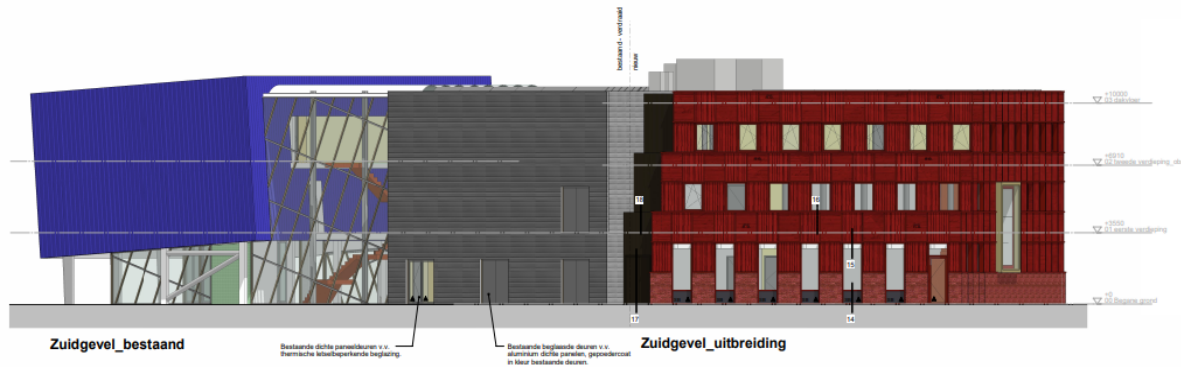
Situatietekening ligging uitbreiding theater De Omval
